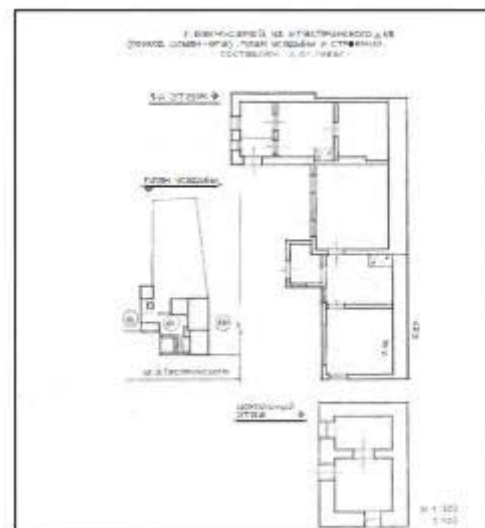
План садиби і будов будинку з виступаючими дерев'яними консолями (вул. І. Гаспринського, 8) / Fig. 6. House plan and buildings with protruding wooden consoles (I. Gasprinsky St., 8)
